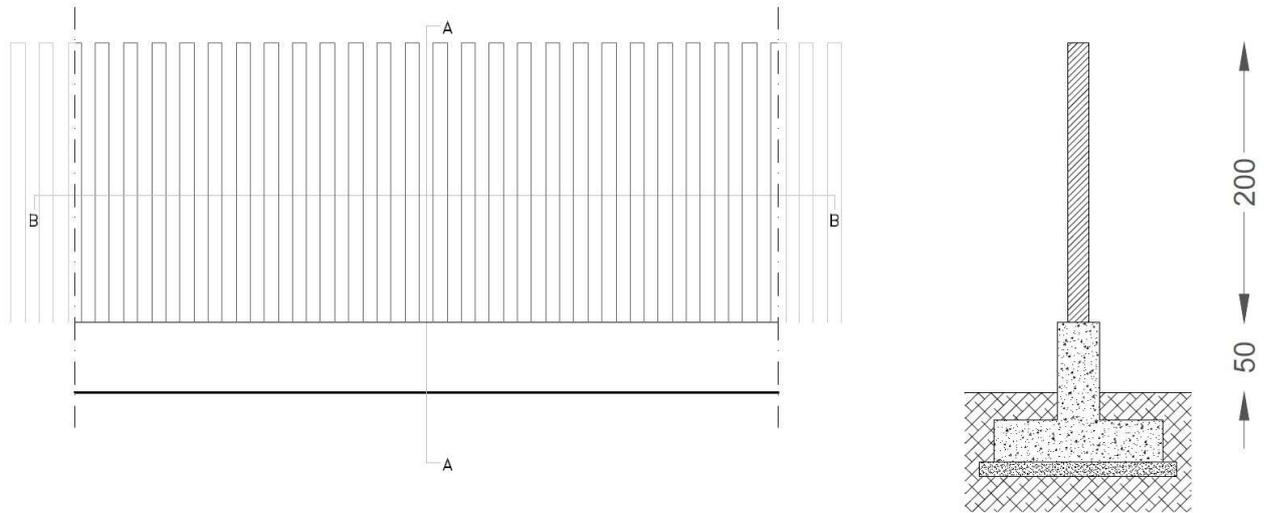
Particolare recinzione Stazione utente di trasformazione
